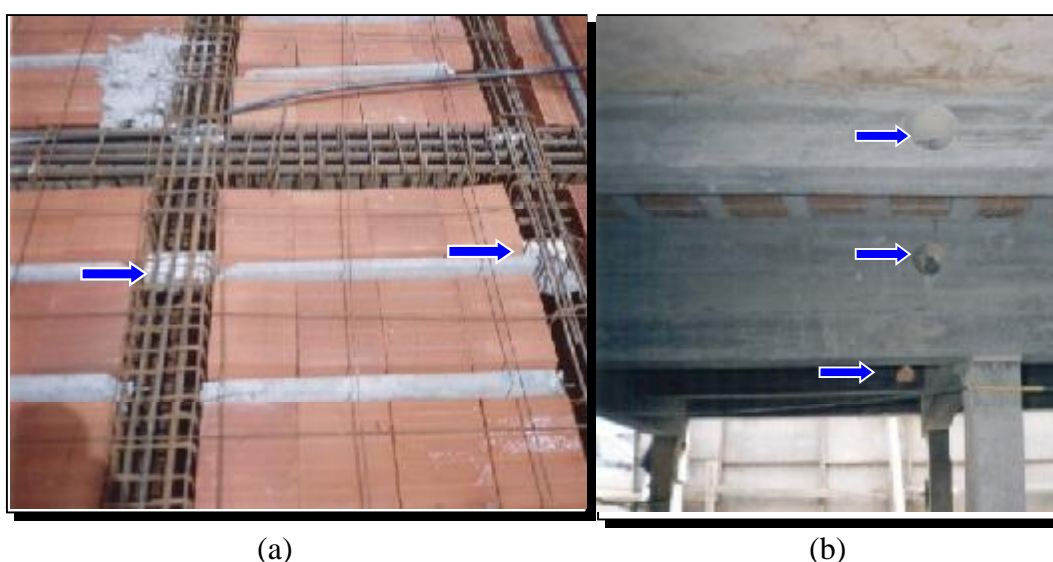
Furos para passagem de tubulação através da estrutura do primeiro pavimento.
